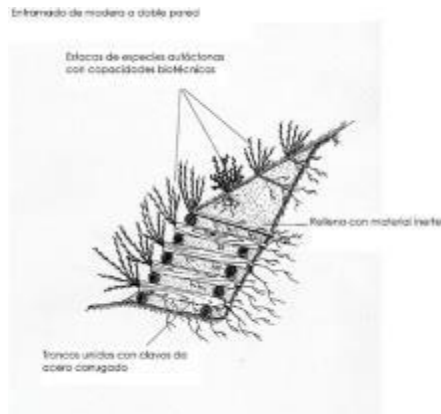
Técnica mixta. Esquema de la estructura de madera (EFIB, Paola Sangalli).
